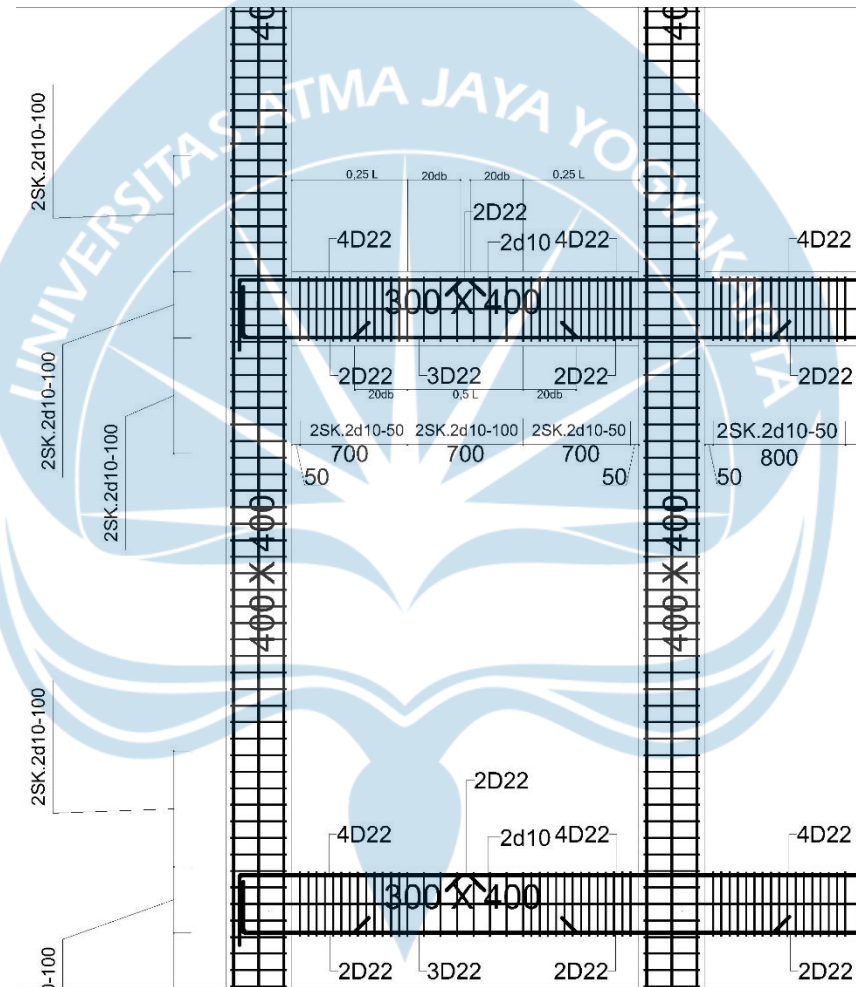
Detail penulangan balok lantai dag as 2-6
